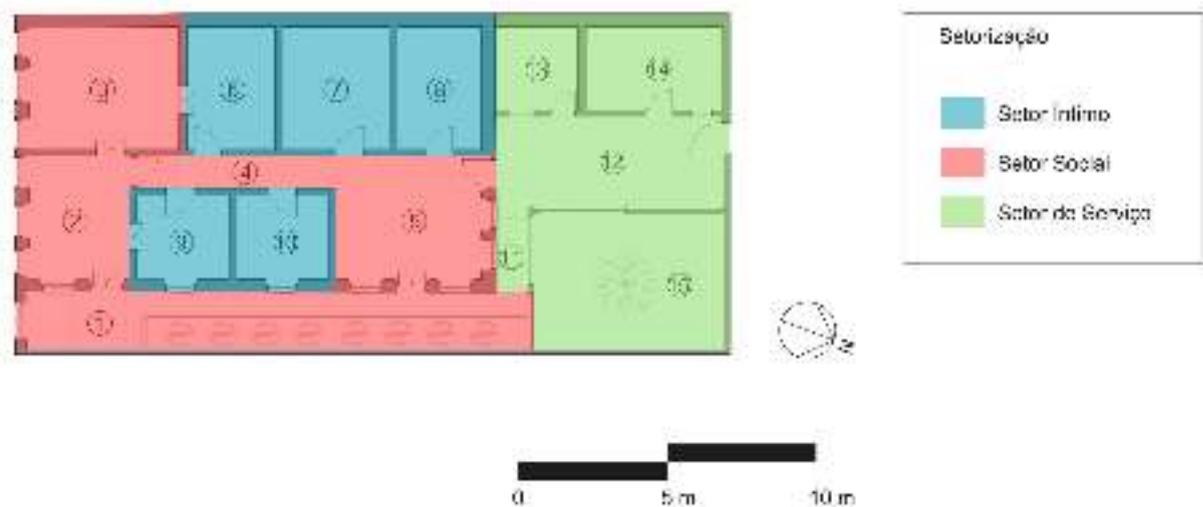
Planta Baixa da casa do Barão da Lagoa em 1849
